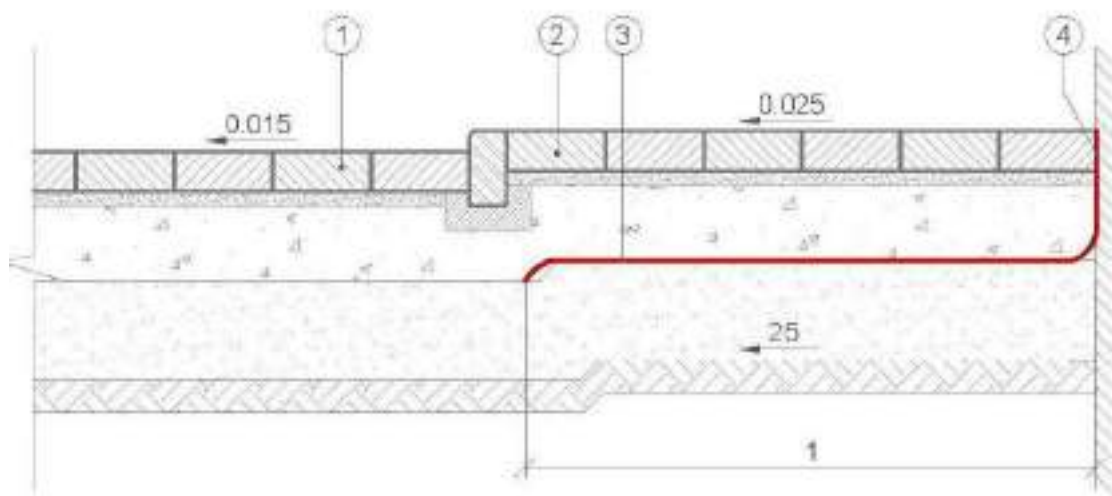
Гидроизоляция подземных частей зданий, к которым примыкает мощение
